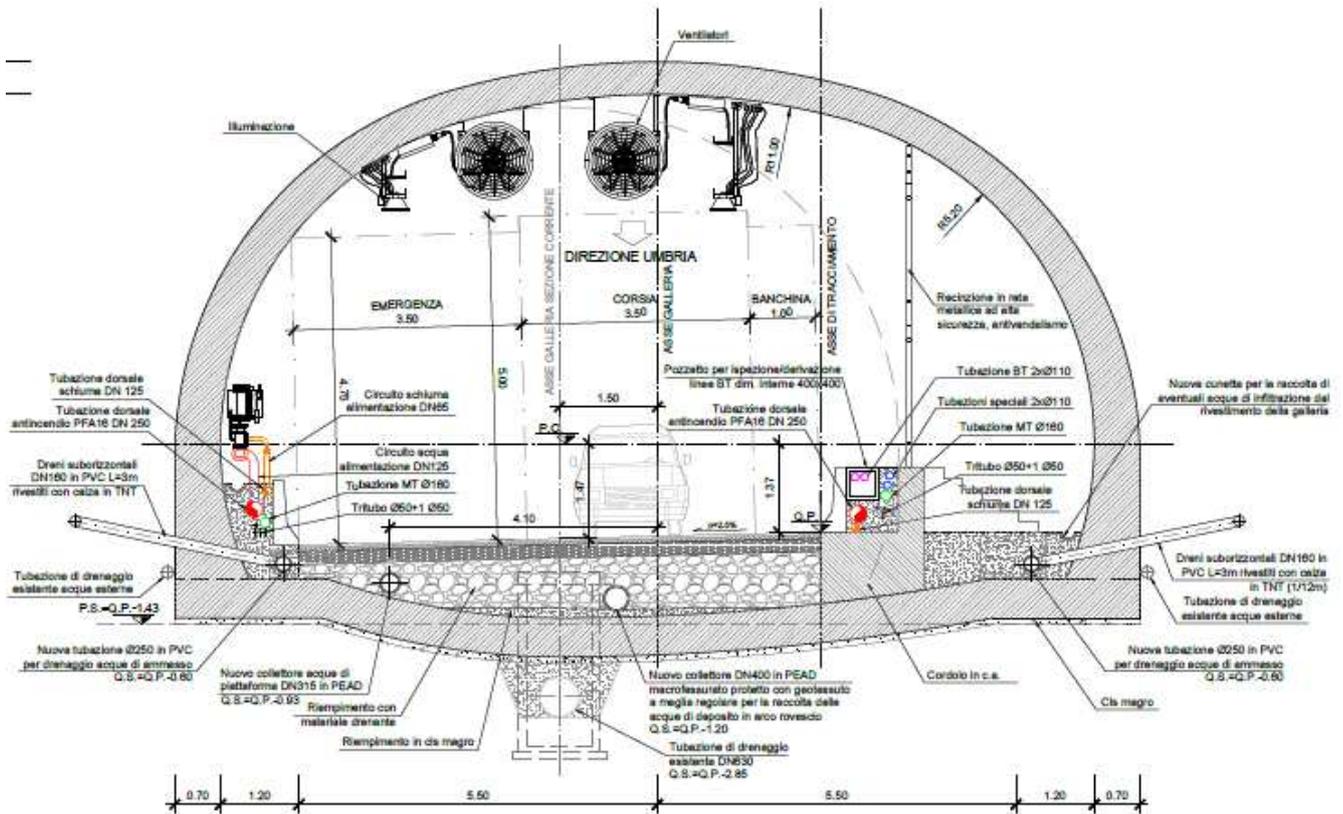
Galleria Guinza - Sistemazione idraulica – Piazzola di sosta
